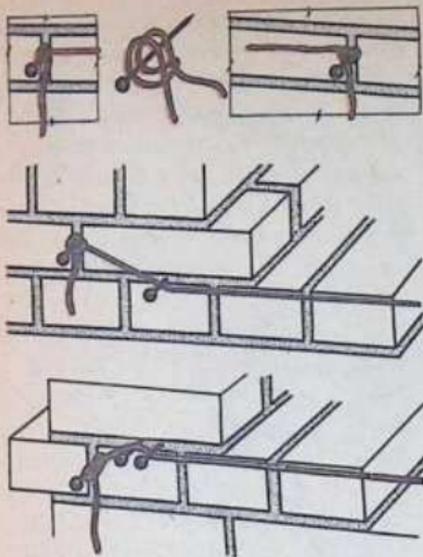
Укрепление шнура-причалки двойной петлей за гвозди
